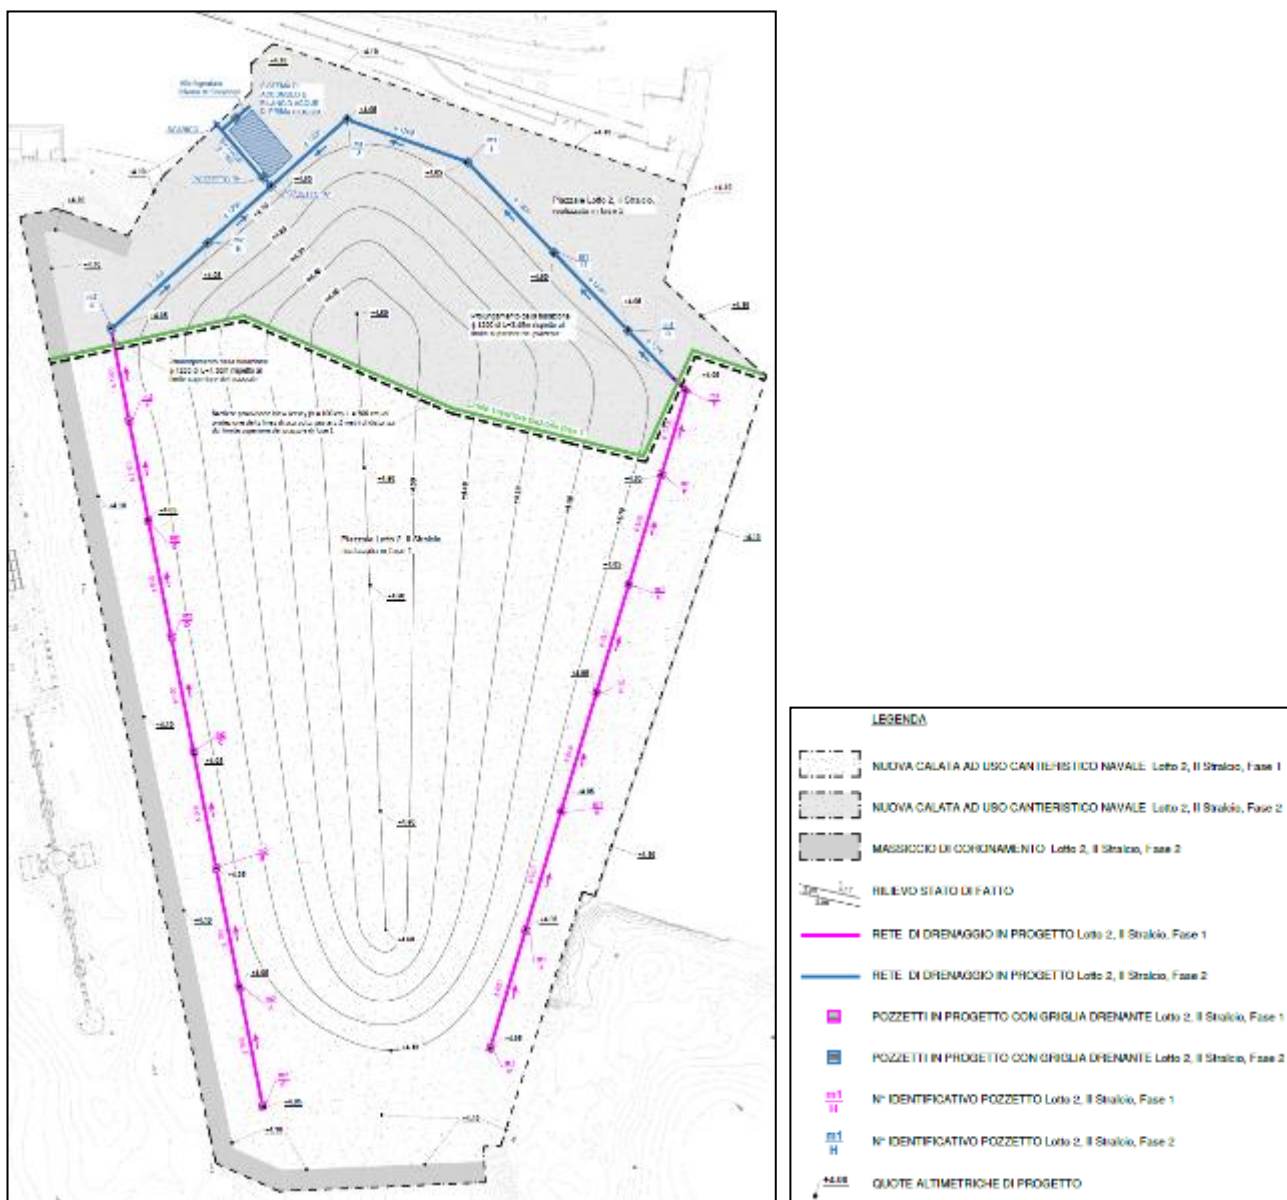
Nuova cassa di colmata. Planimetria opere in progetto relative alle Fasi 1 e 2 del Lotto 2- II Stralcio
